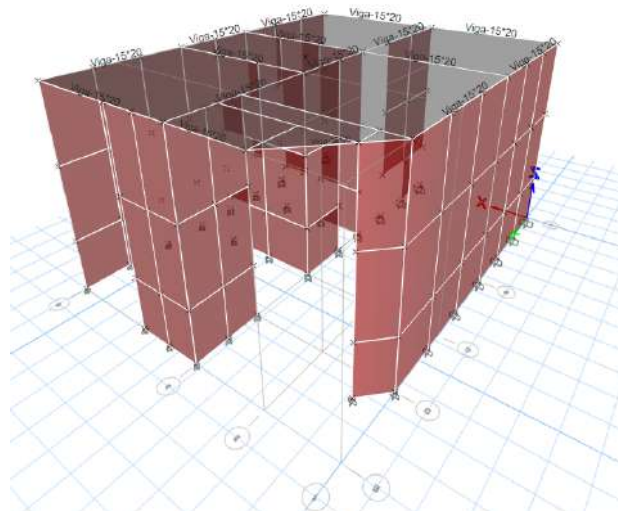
Vista en planta del modelamiento de la vivienda 03
